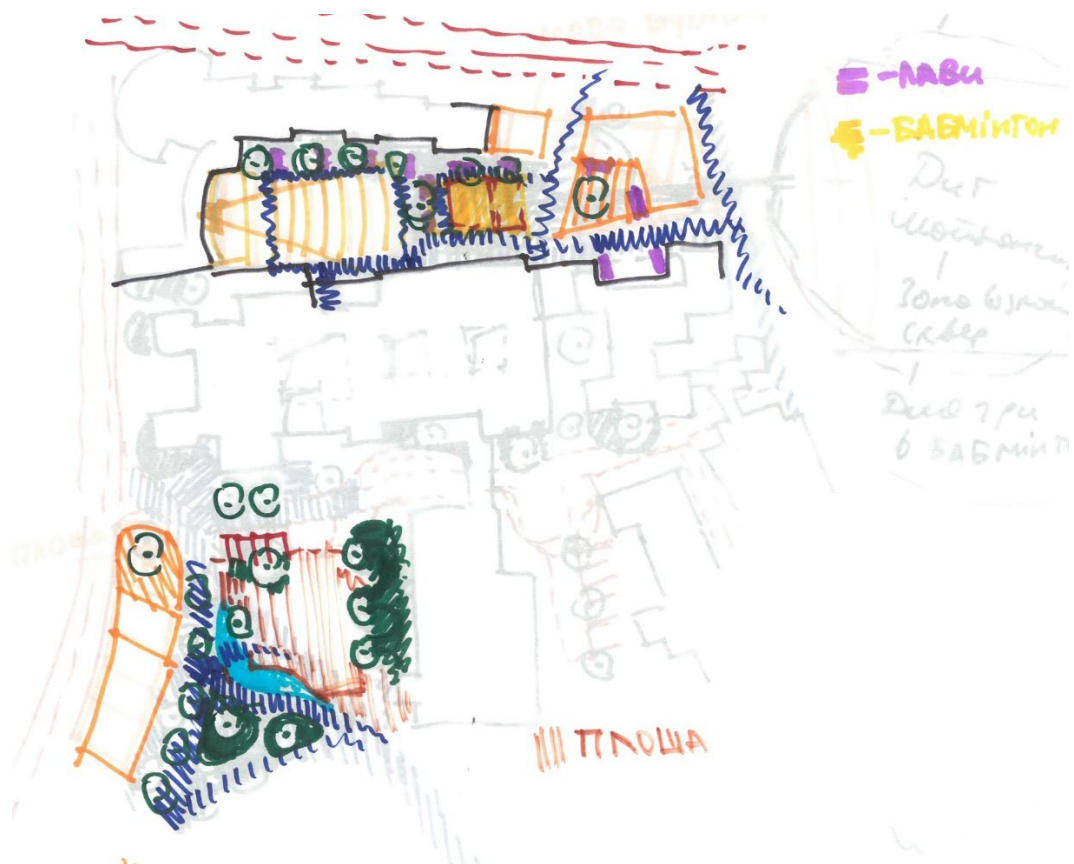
Генеральний план з схемою внутрішнього двору та скверу
